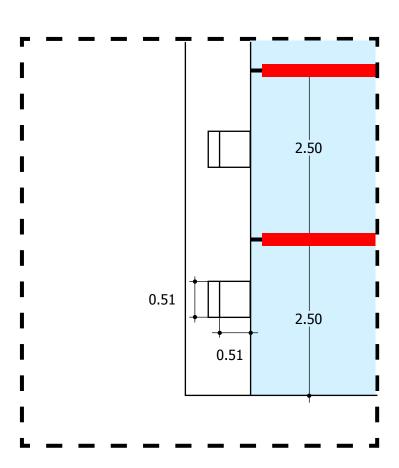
del anexo SW1 de las FINA FACILITIES RULES con ancho de carriles
